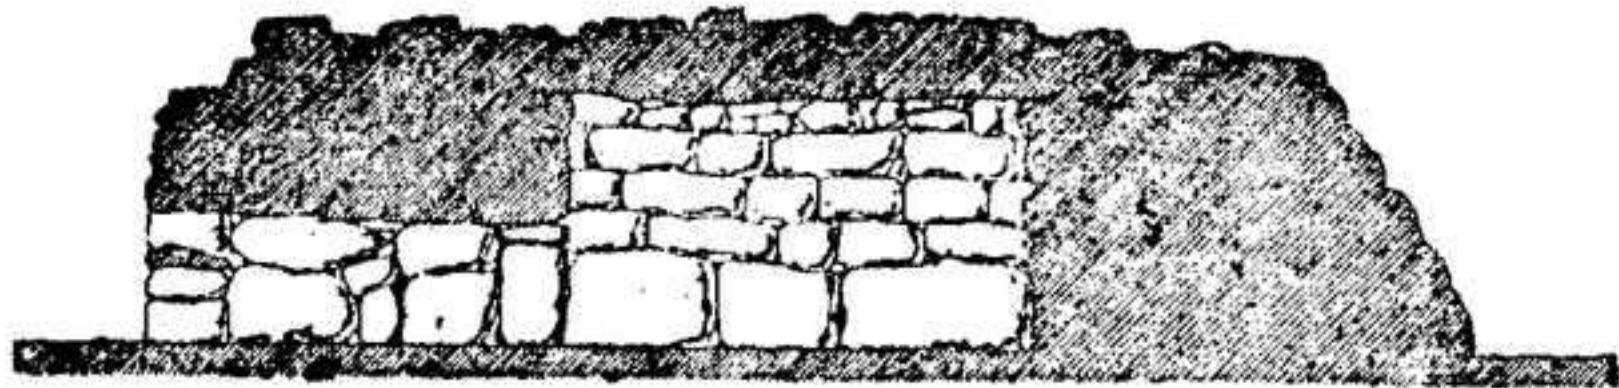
Naueta de Son Marcer de Baix. — Corte y planta
